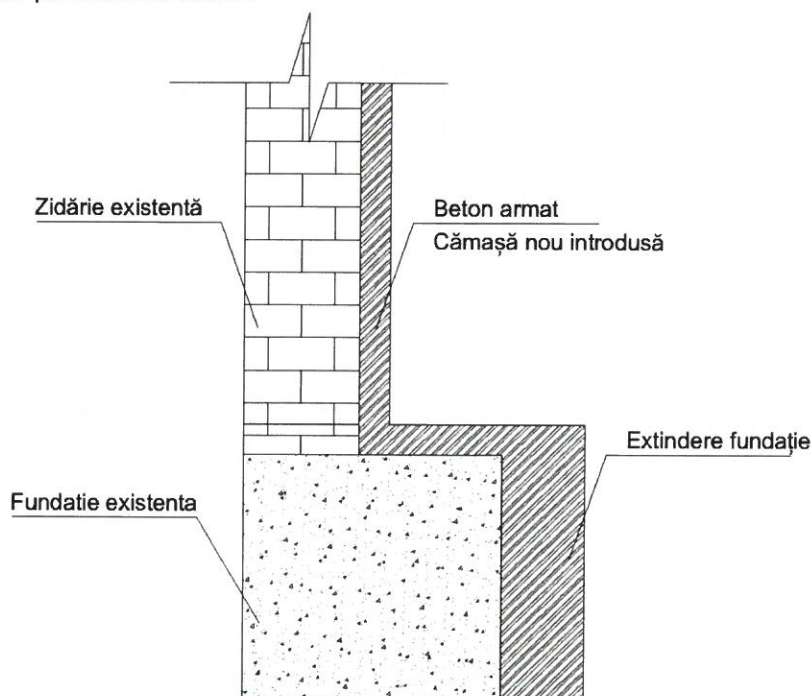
Detaliu tip realizare fundație din beton nou introdusă perete exterior
